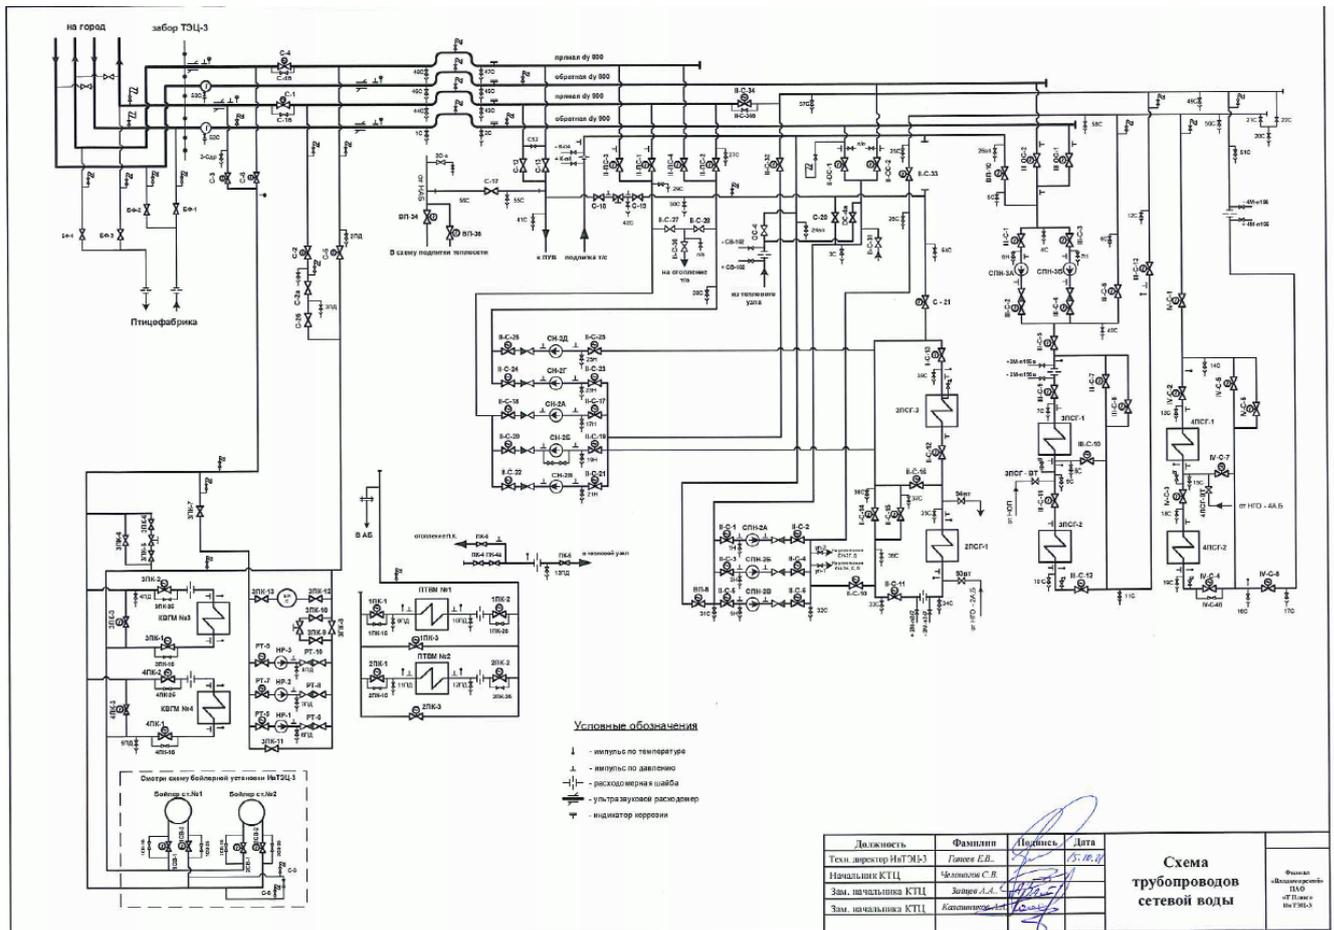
Схема трубопроводов теплосети ИвТЭЦ-3
